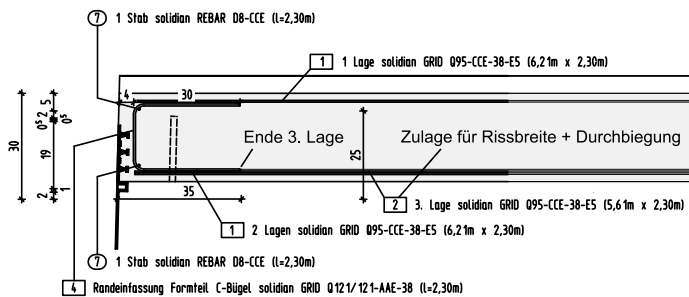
Detailauszug aus Bewehrungsplan Überbau Carbonbetonbrücken Kreuzau (Quelle: Cornelissen + Partner Beratende Ingenieure mbB)
